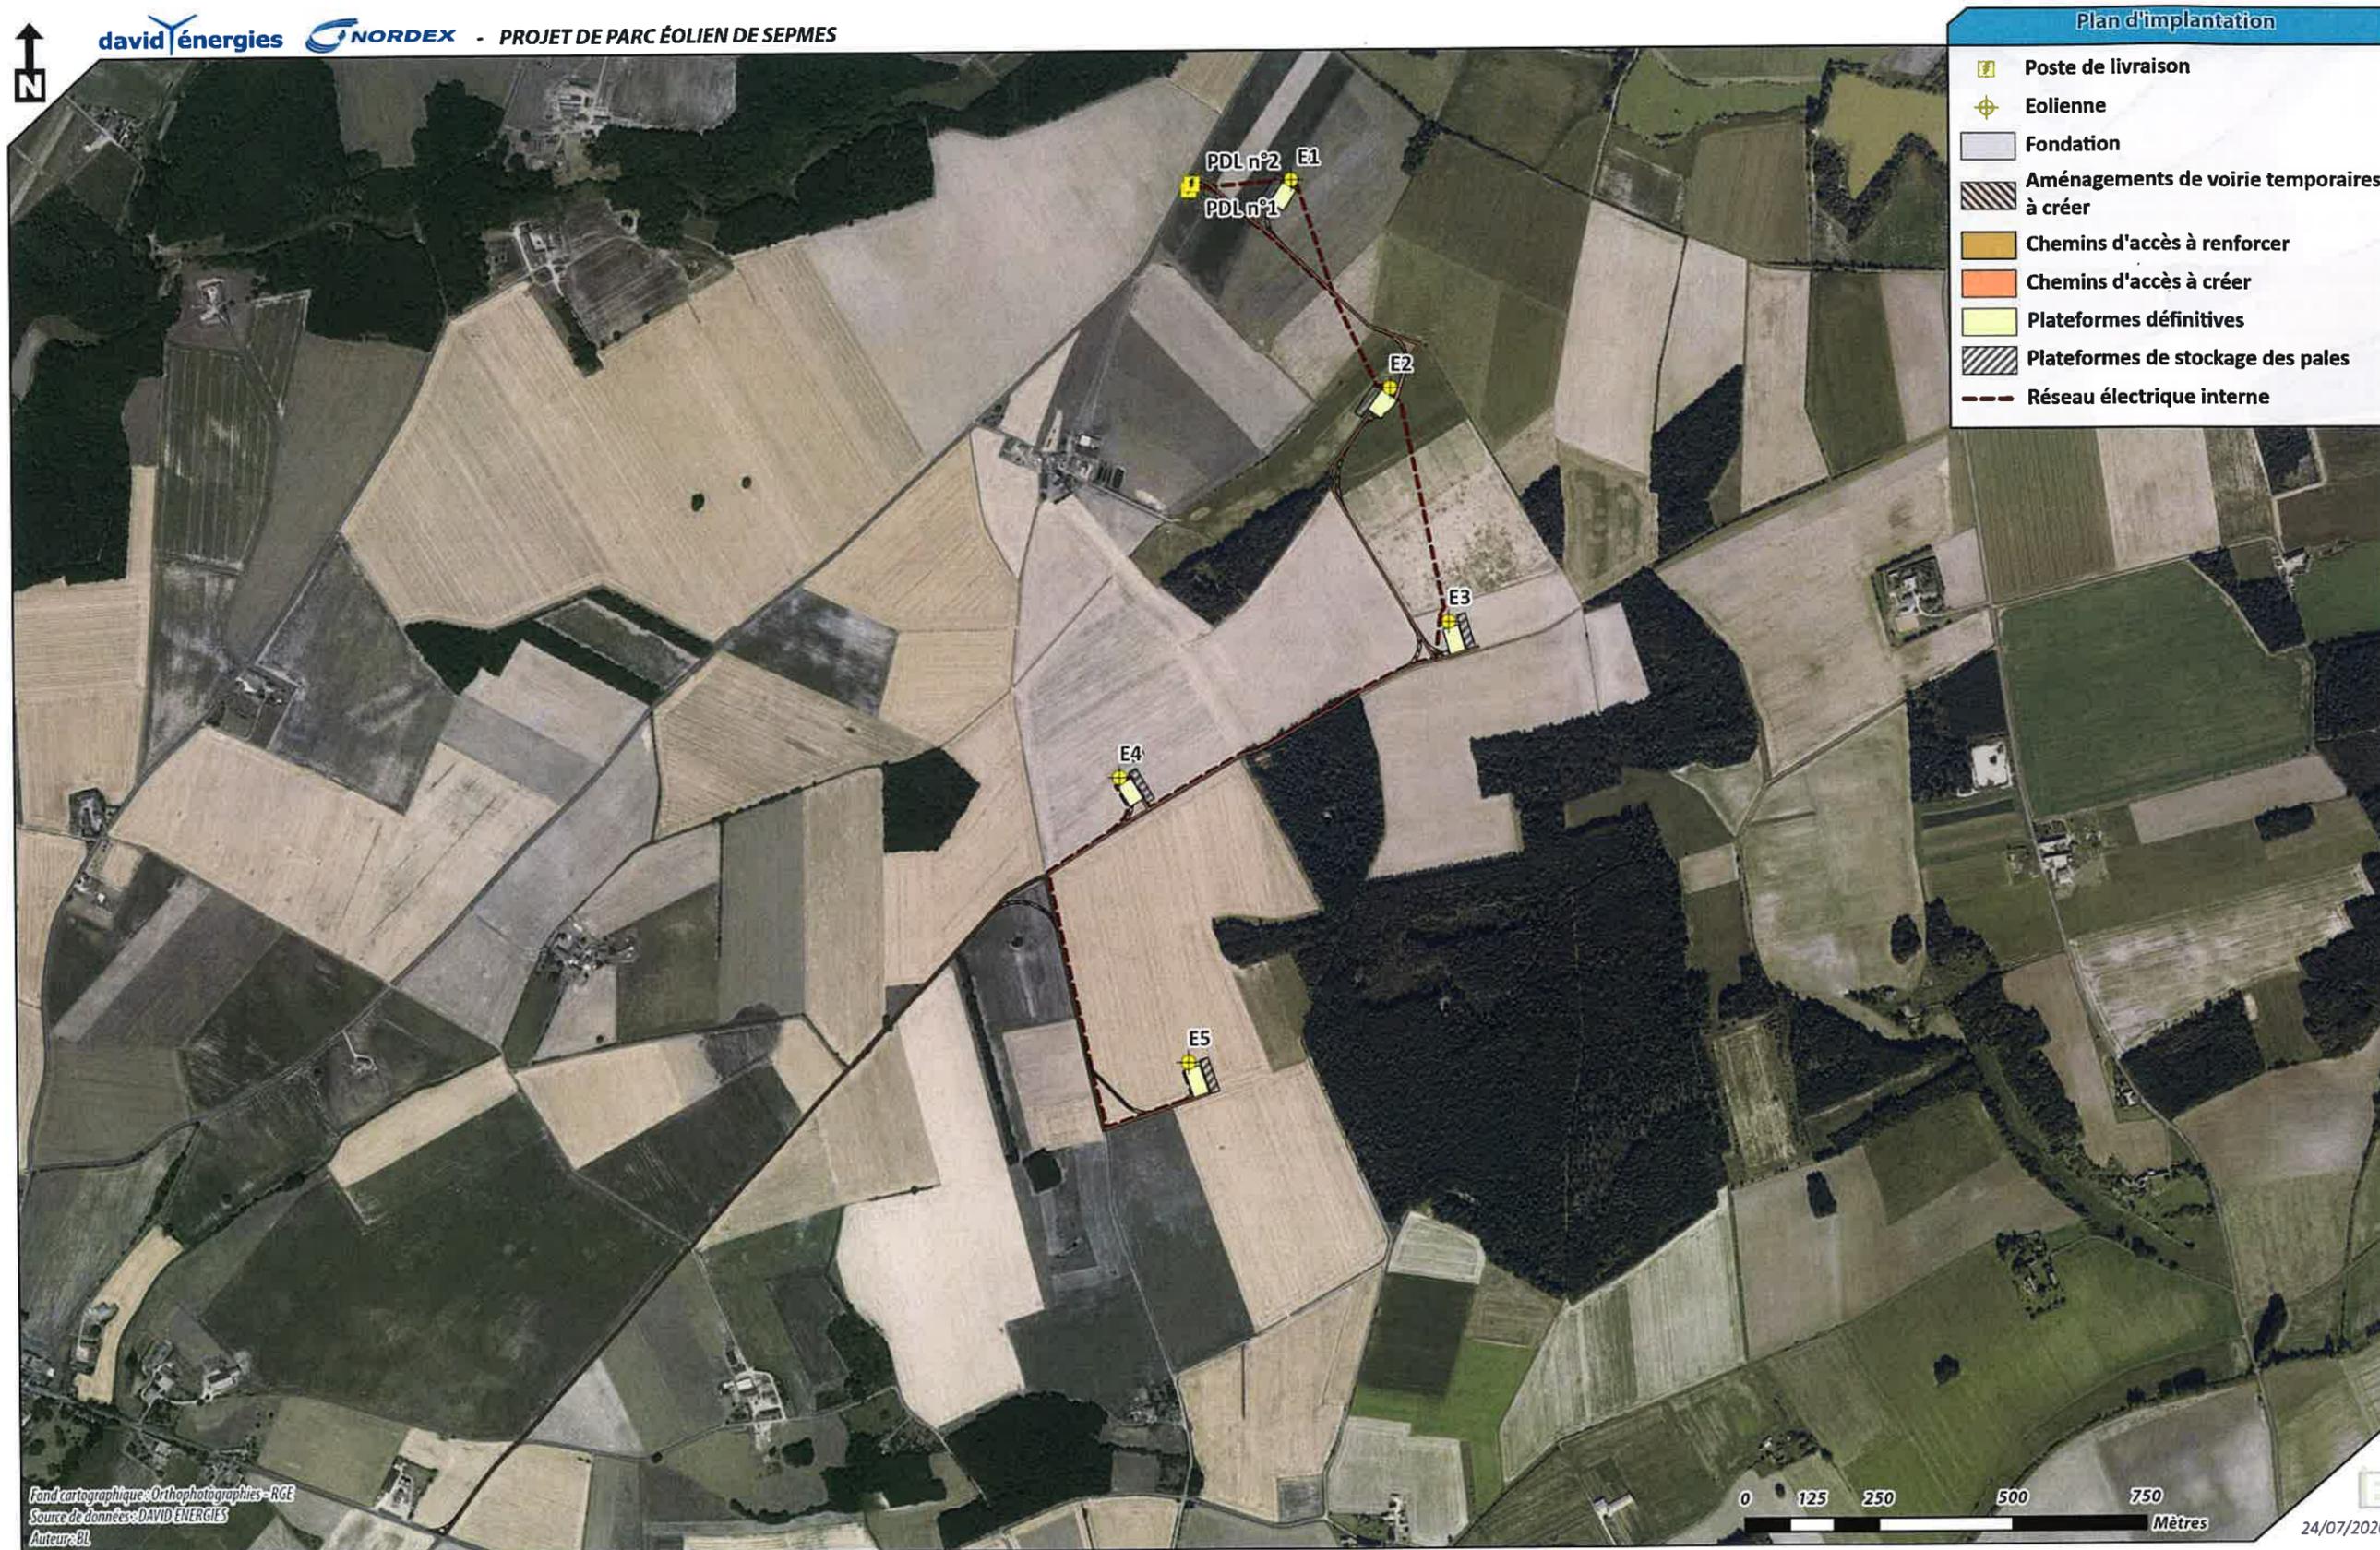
Plan d'implantation du projet de Parc éolien de Sepmes
